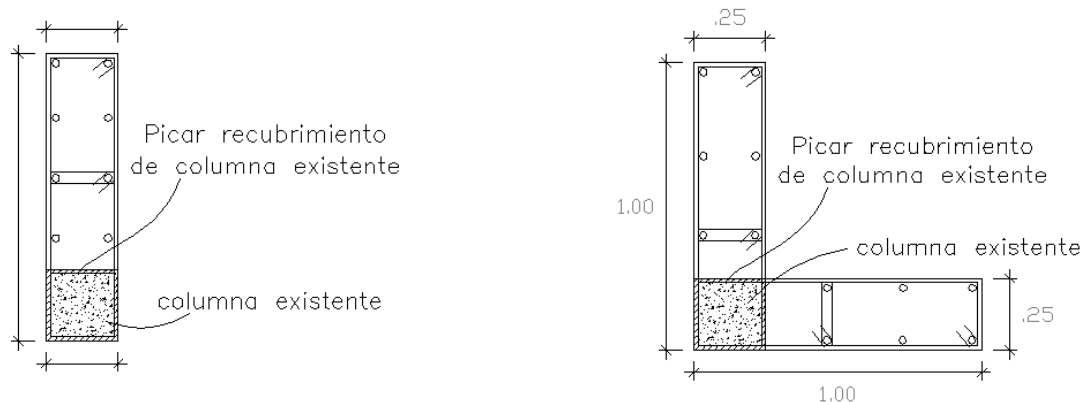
Detalle de reforzamiento para columna existente y esquinera
